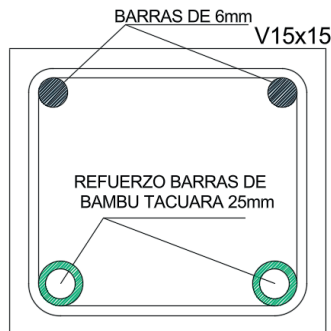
Esquema de viga con refuerzo mixto o híbrido (acero y bambú).
